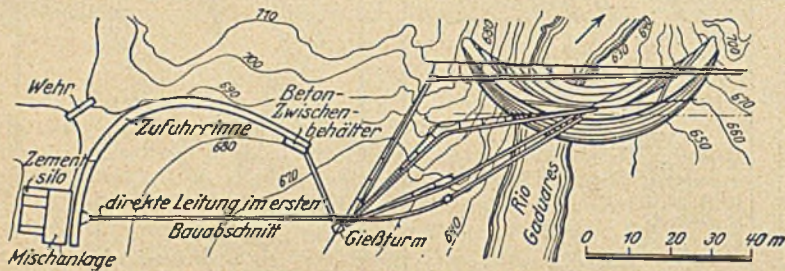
Grundriß der Staumauer und der Baustelleneinrichtung.
